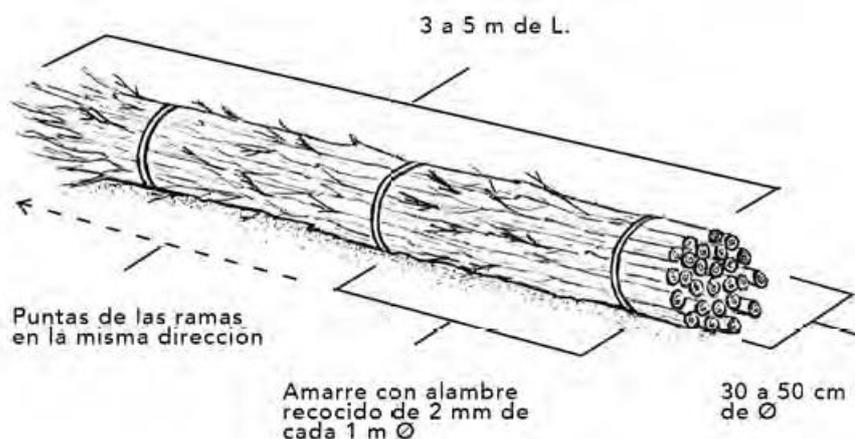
ILUSTRACIÓN DE FAJINA PARA USO EN OBRAS DE RESTAURACIÓN RIPERIA
